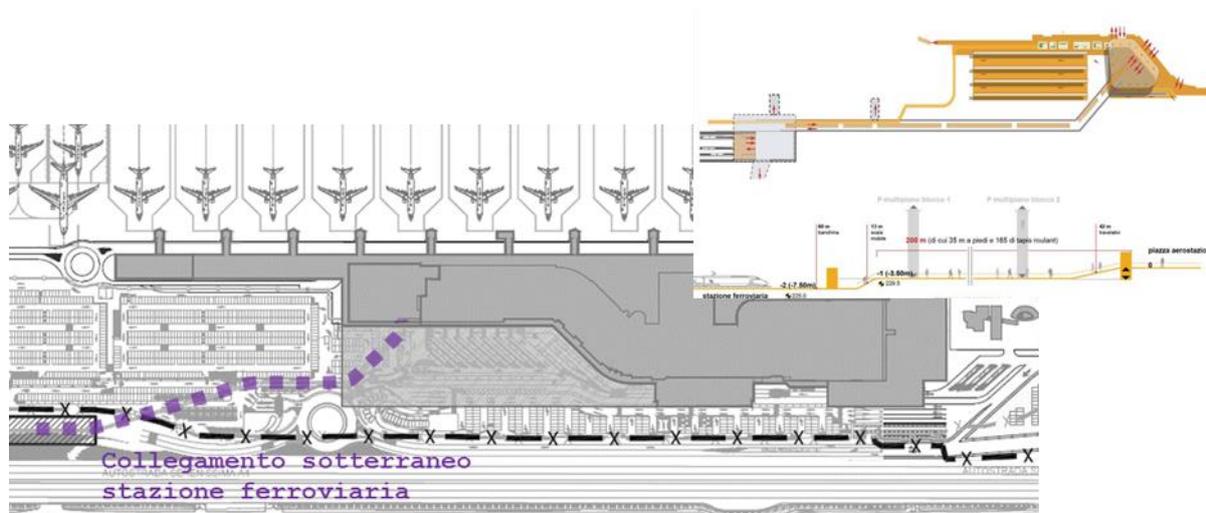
Collegamento sotterraneo tra la stazione ferroviaria e l'aerostazione (Intervento A1, opera complementare)
